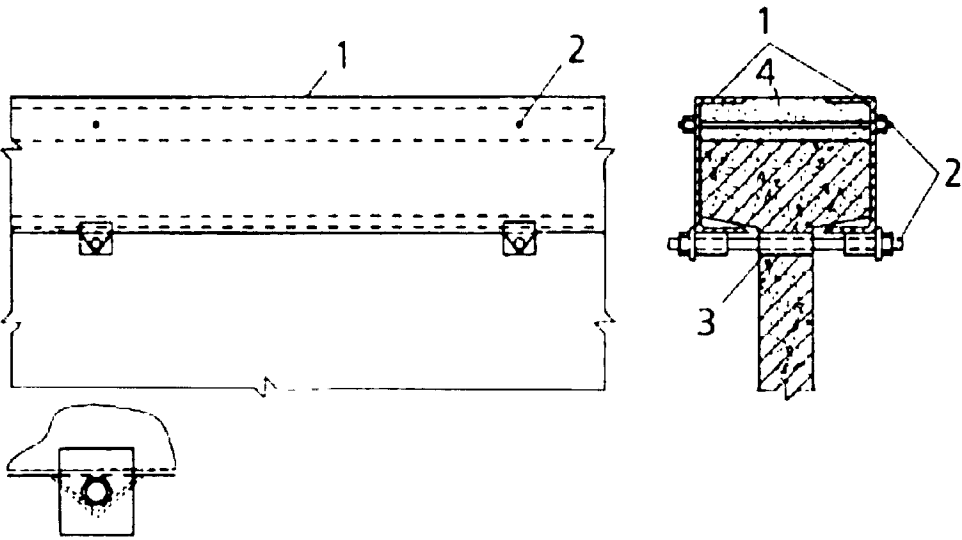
Металлобетонная обойма: 1 - швеллеры; 2 - стяжные болты; 3 - отверстие для болта в стенке балки; 4 - монолитный бетон
